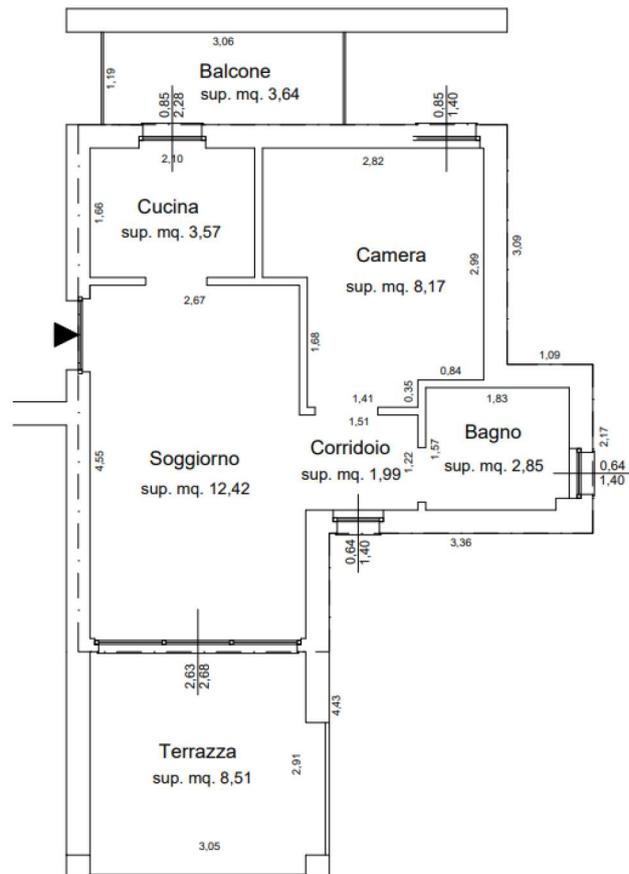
Pianta dello stato dei luoghi come da rilievo effettuato in data 06/12/2021.
